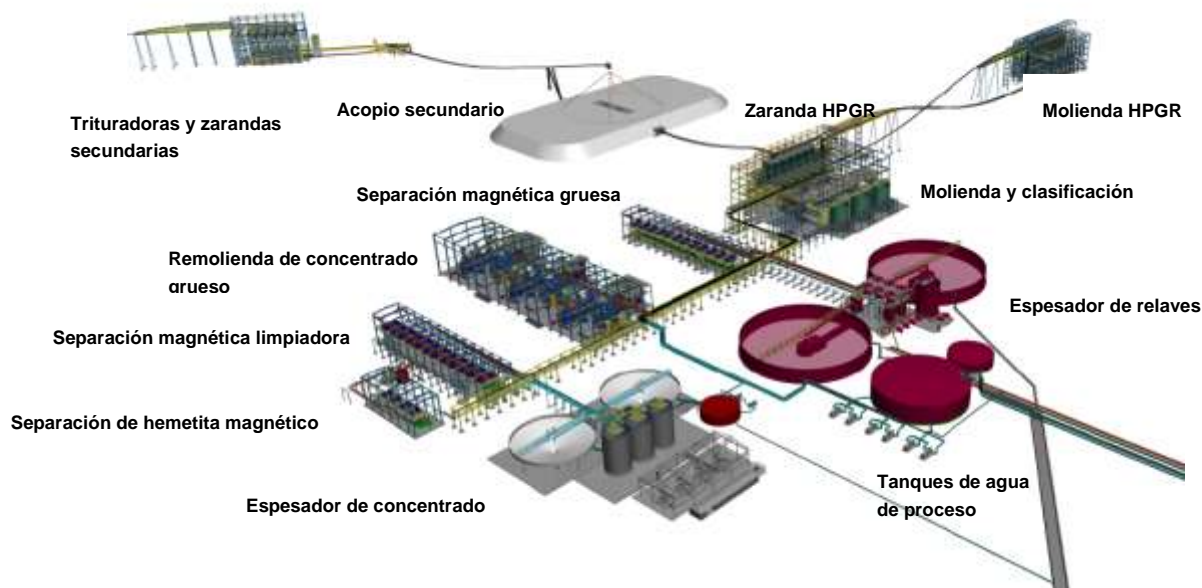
Disposición General de la Planta de Beneficiamiento
